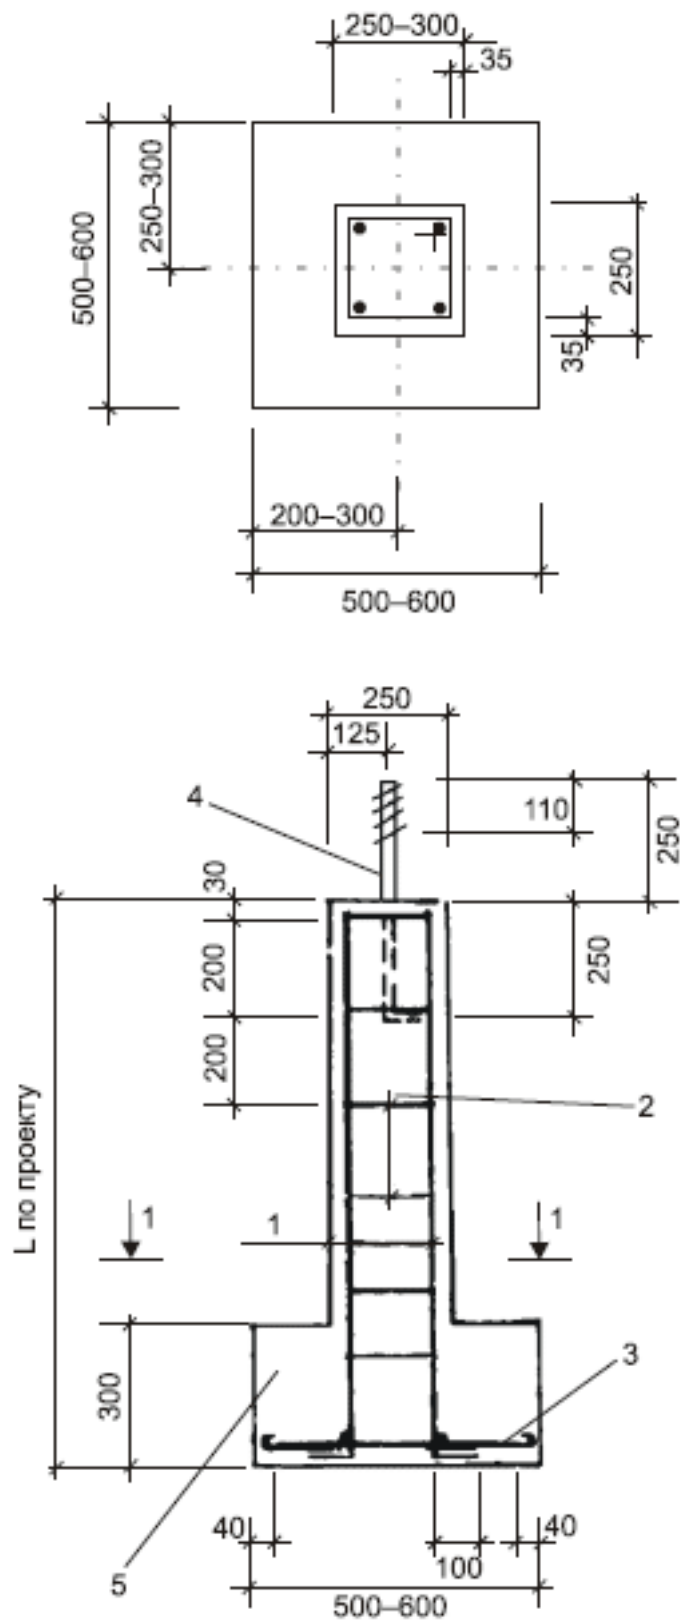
Конструкция железобетонного столбчатого фундамента: 1 – стержень из арматуры диаметром 10 мм; 2 – хомуты (арматура диаметром 6 мм); 3 – сетка арматурная с ячейками 150x150 мм из проволоки диаметром 6 мм; 4 – анкерный болт М16; 5 – бетон В15 (М200)
